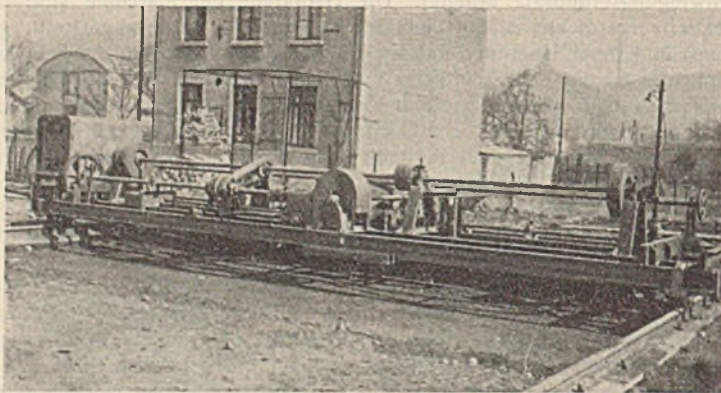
Betonstraßenfertiger mit ebener Stampfbohle und Verteiler.
